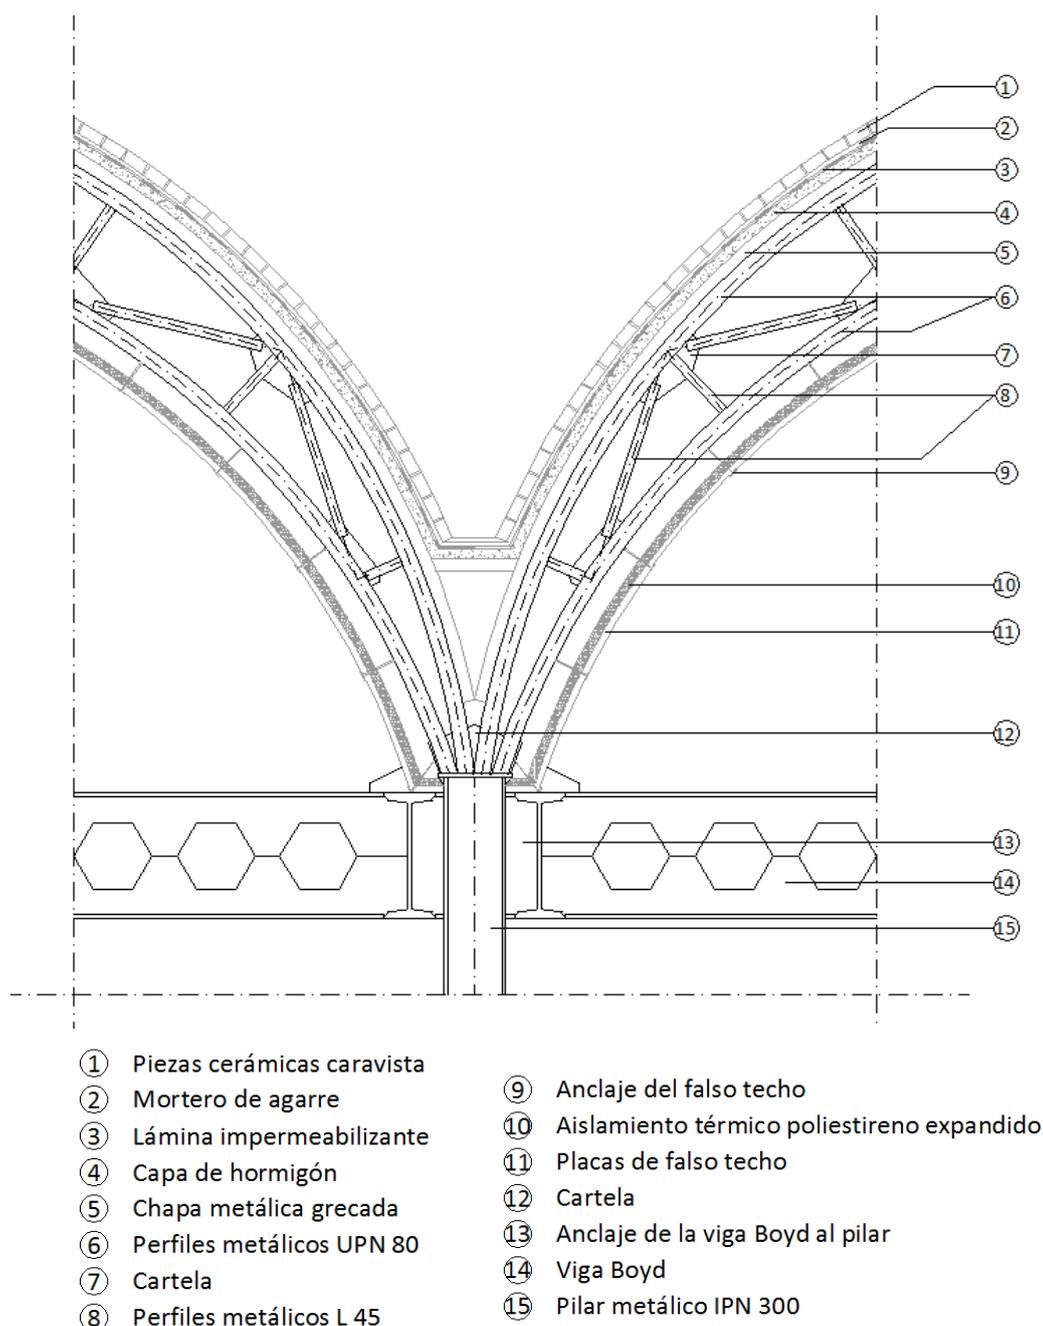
Detalle constructivo de la sección de la cubierta. (Fuente: propia)
